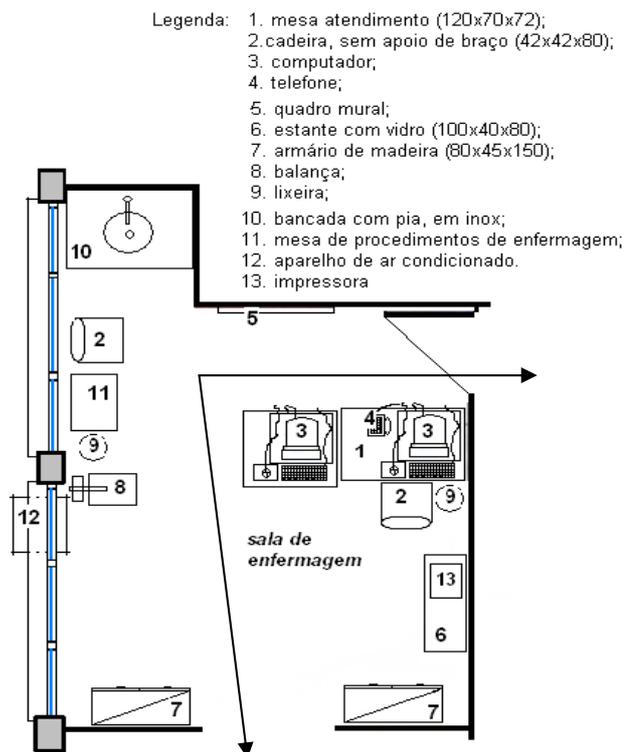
Planta baixa da sala de enfermagem (sem escala)
